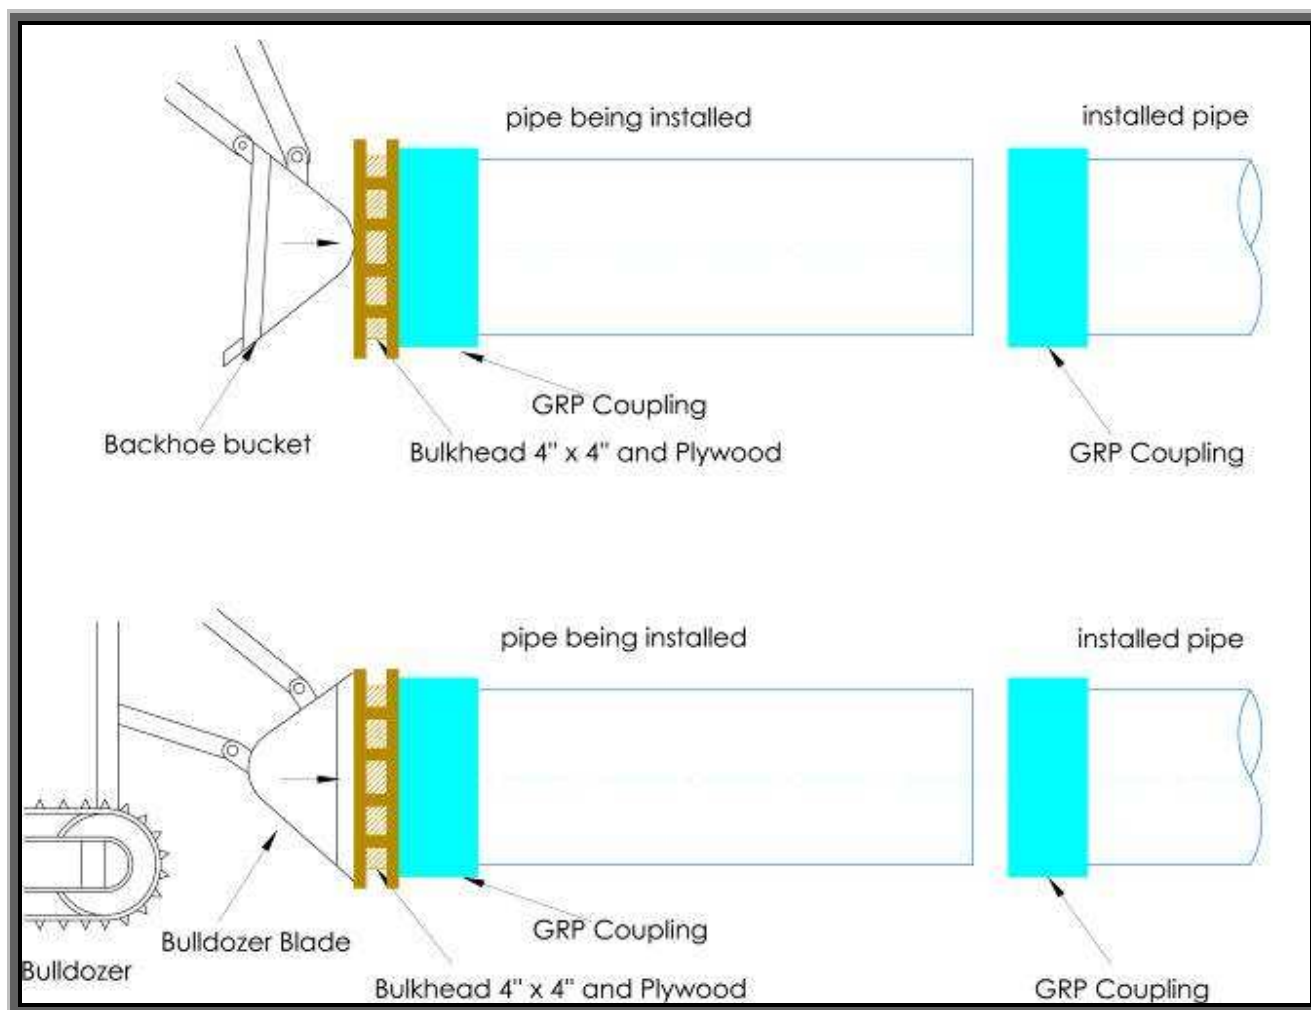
Instalare cu cupa excavatorului sau buldozer
